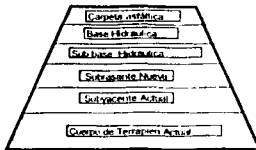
Cálculo para el diseño estructural de pavimentos con movimiento flexible.
